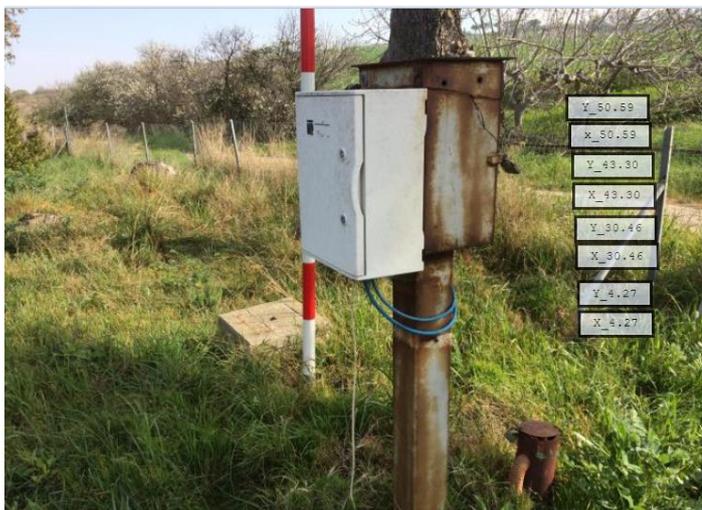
Inclinometro fisso (29.5m) a lettura automatica in posizione sondaggio S8
